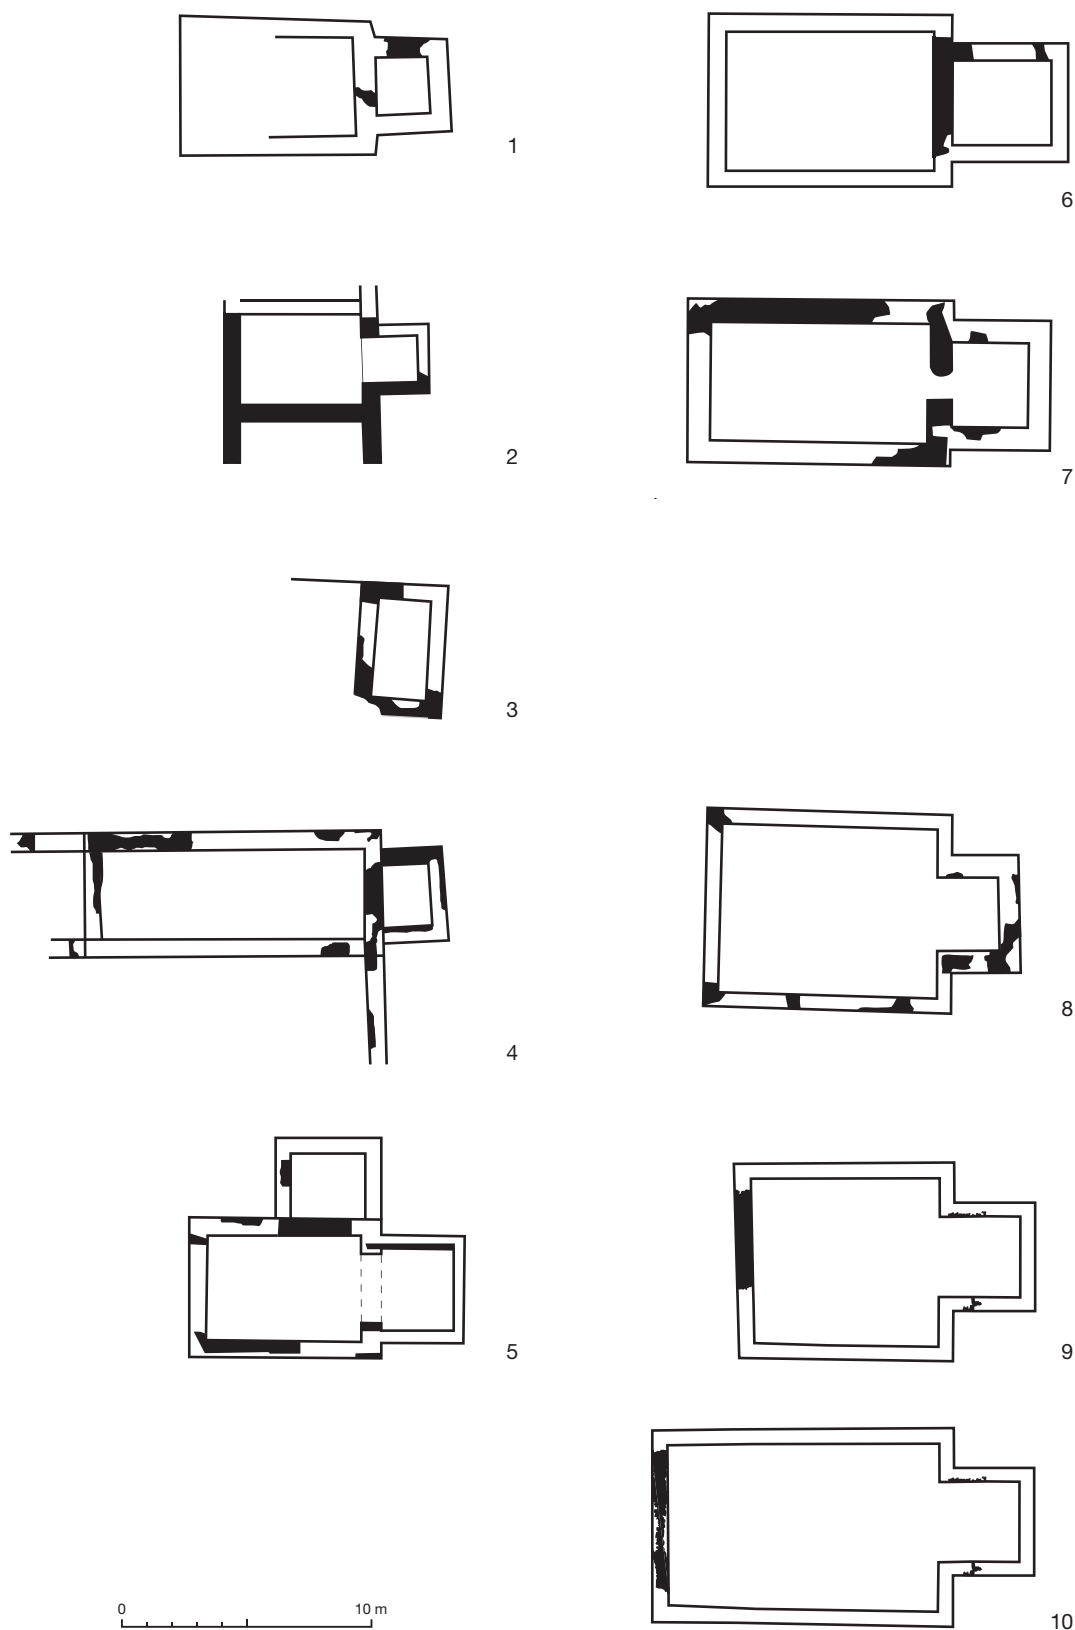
Beispiele von späteren frühmittelalterlichen Kirchen mit Viereckchor. Schwarze Flächen: Bestand. Linien: rekonstruierter Grundriss. M. 1:300.
